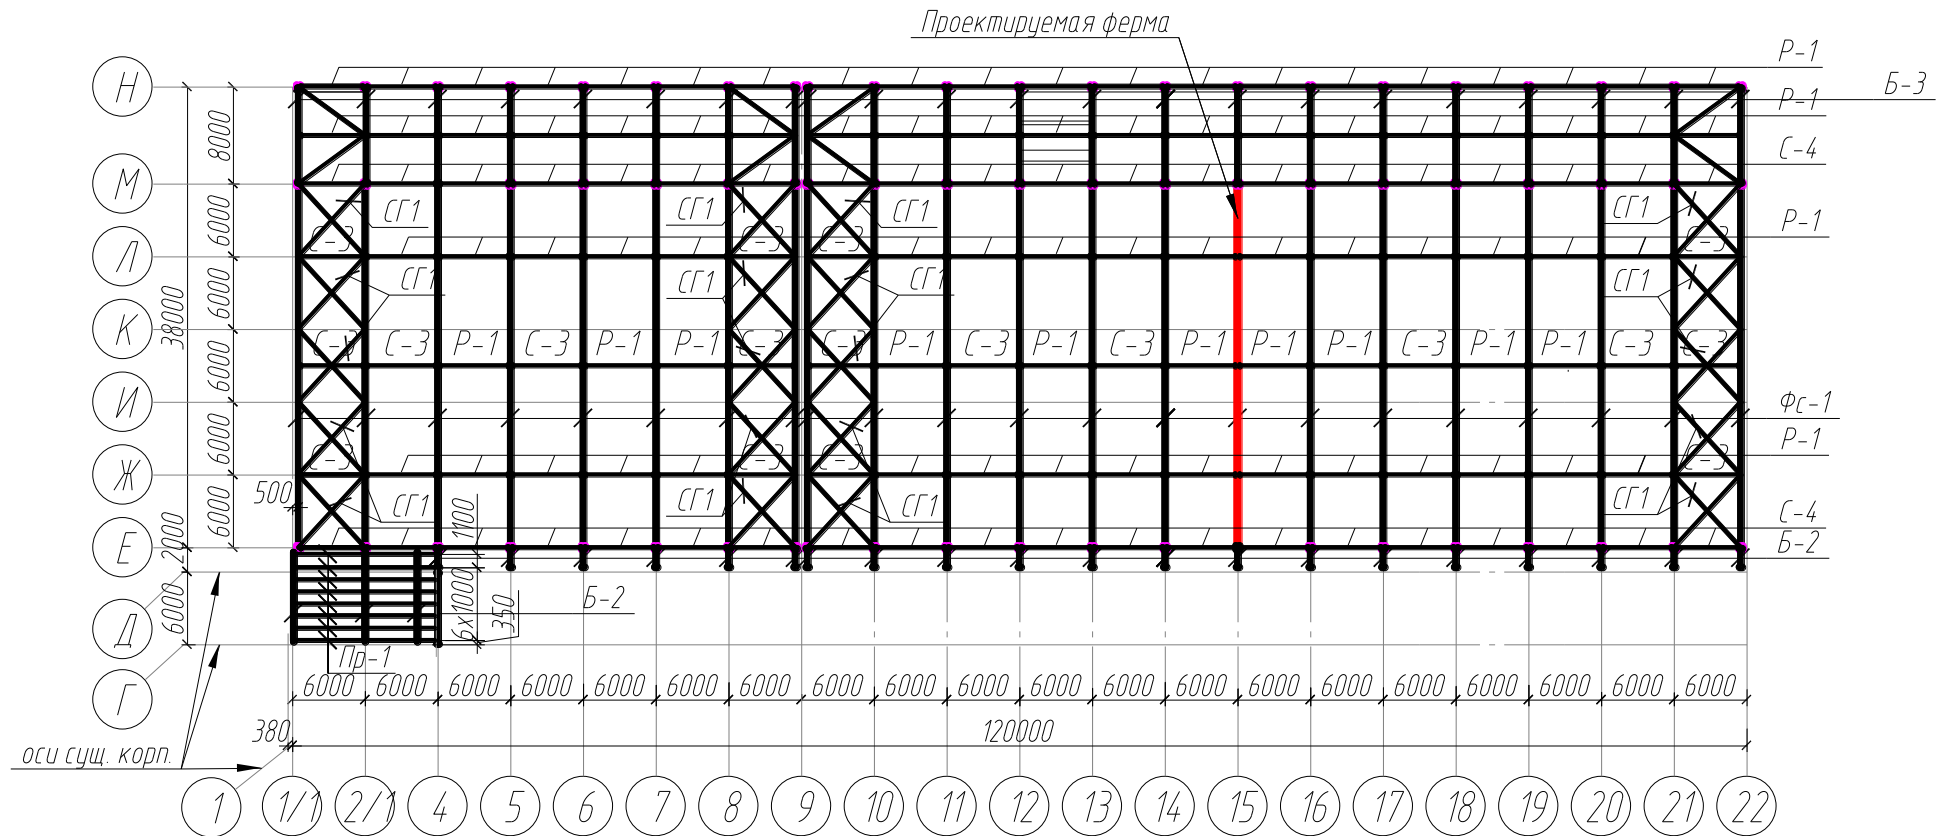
Схема связей и распорок по верхним поясам ферм
